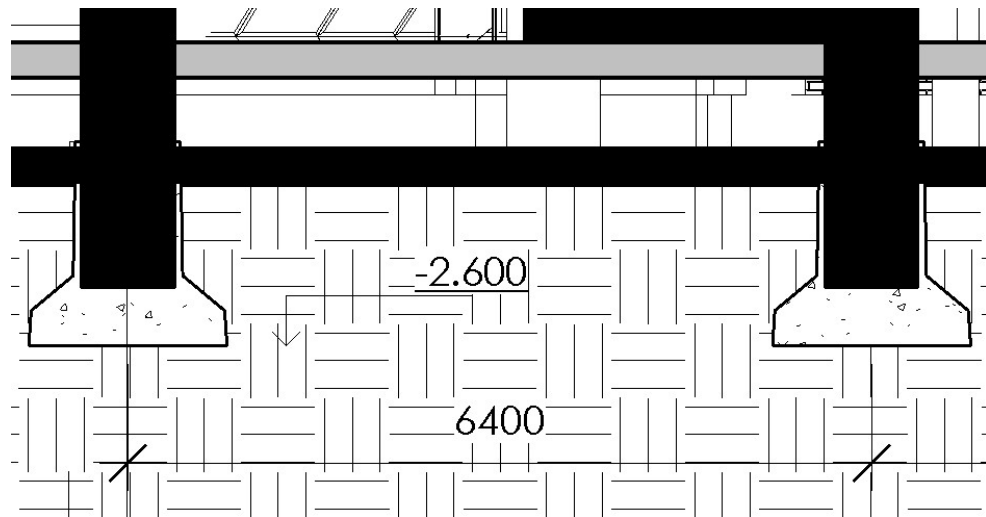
Схема стакану фундаменту з колонами проєкту
